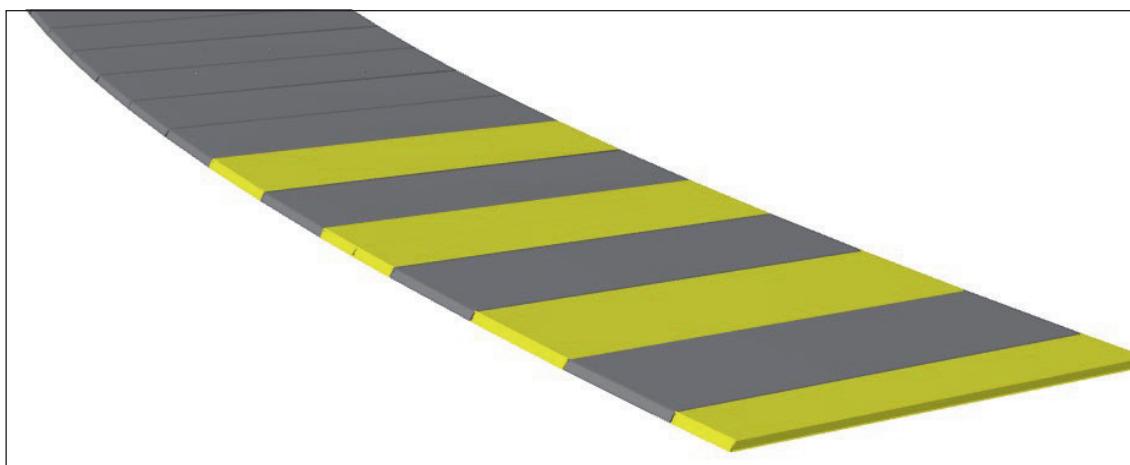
Teiltrassenkörper einer Asphaltdeckschicht
